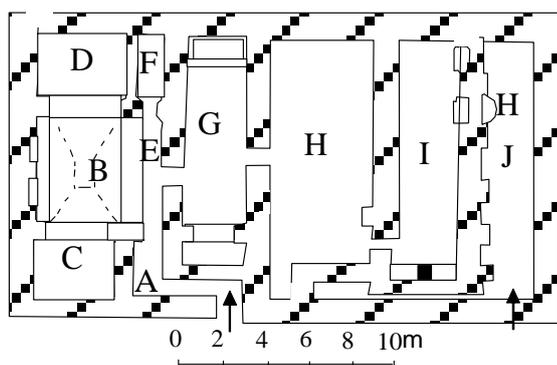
Croquis d'un hammam traditionnel in BENABDELLAH A. 1961
